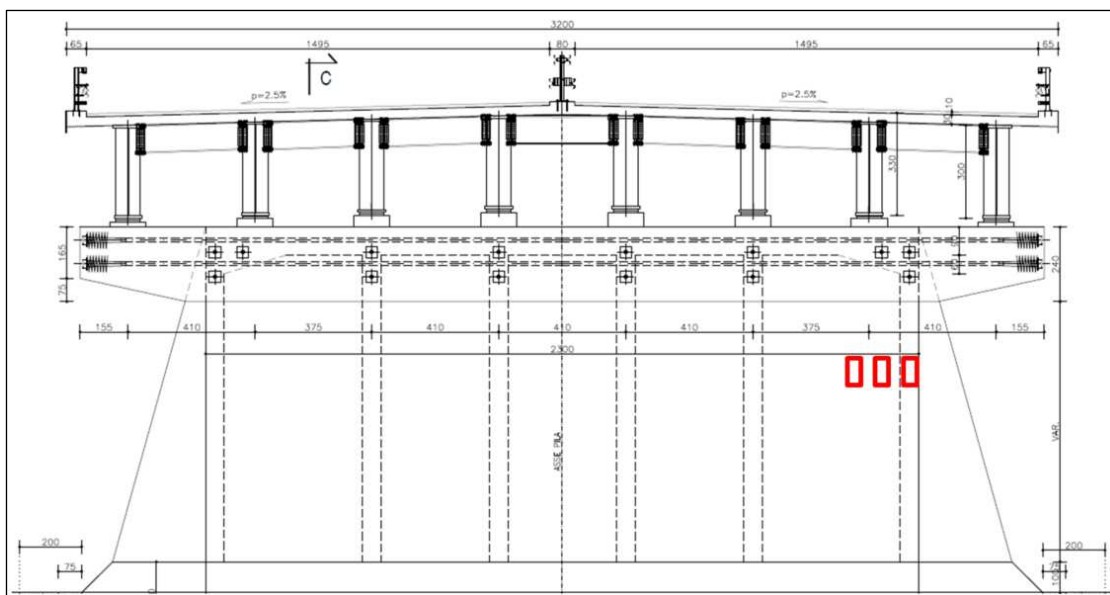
Localizzazione indicativa delle bat box (in rosso) sulle pile a setto, lato sud viadotto
